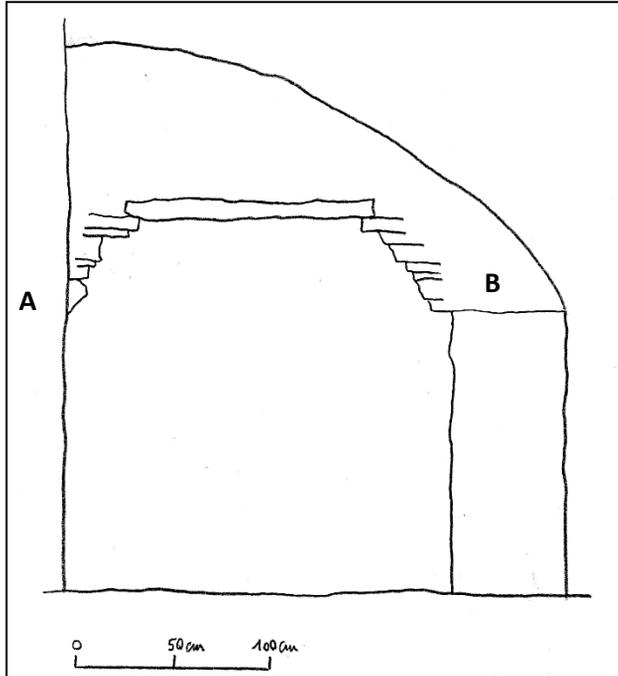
Plafond en encorbellement. Coupe A-B.
